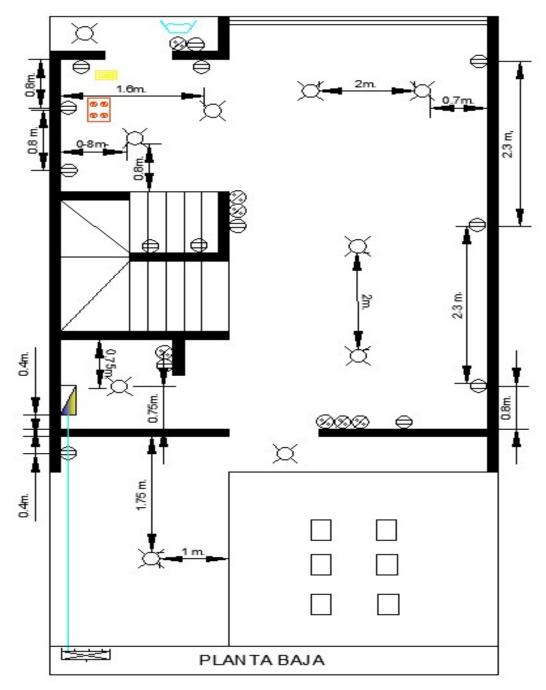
Plano de distribución eléctrica de la planta baja.
